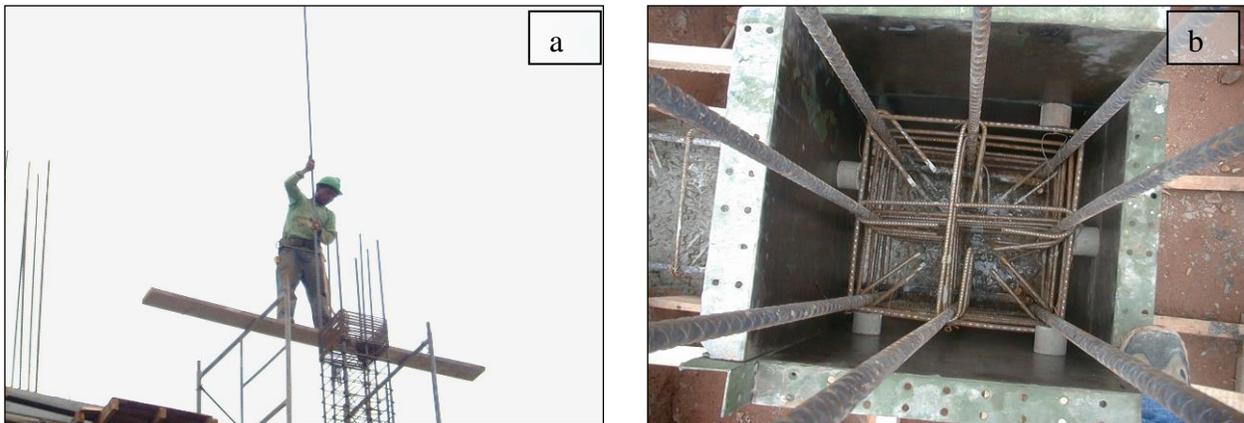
a) Colocación de traslapes de acero longitudinal de columnas, b) Detalle del acero de refuerzo y de los separadores de concreto en el interior de una formaleta para columna.
